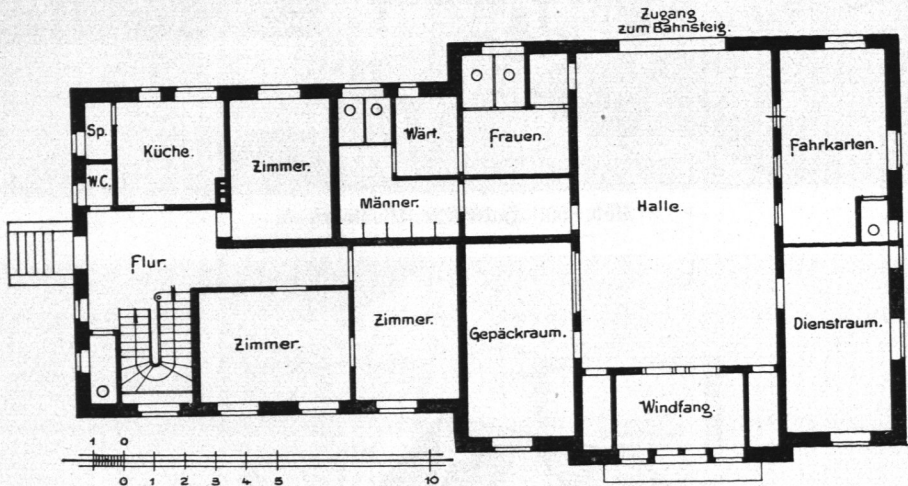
Haltestelle Ahrensburg-West, Erdgeschoß.
